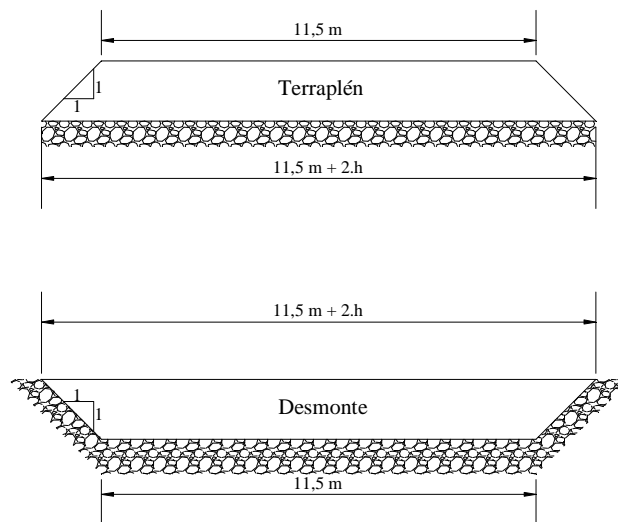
Perfil Transversal Tipo
